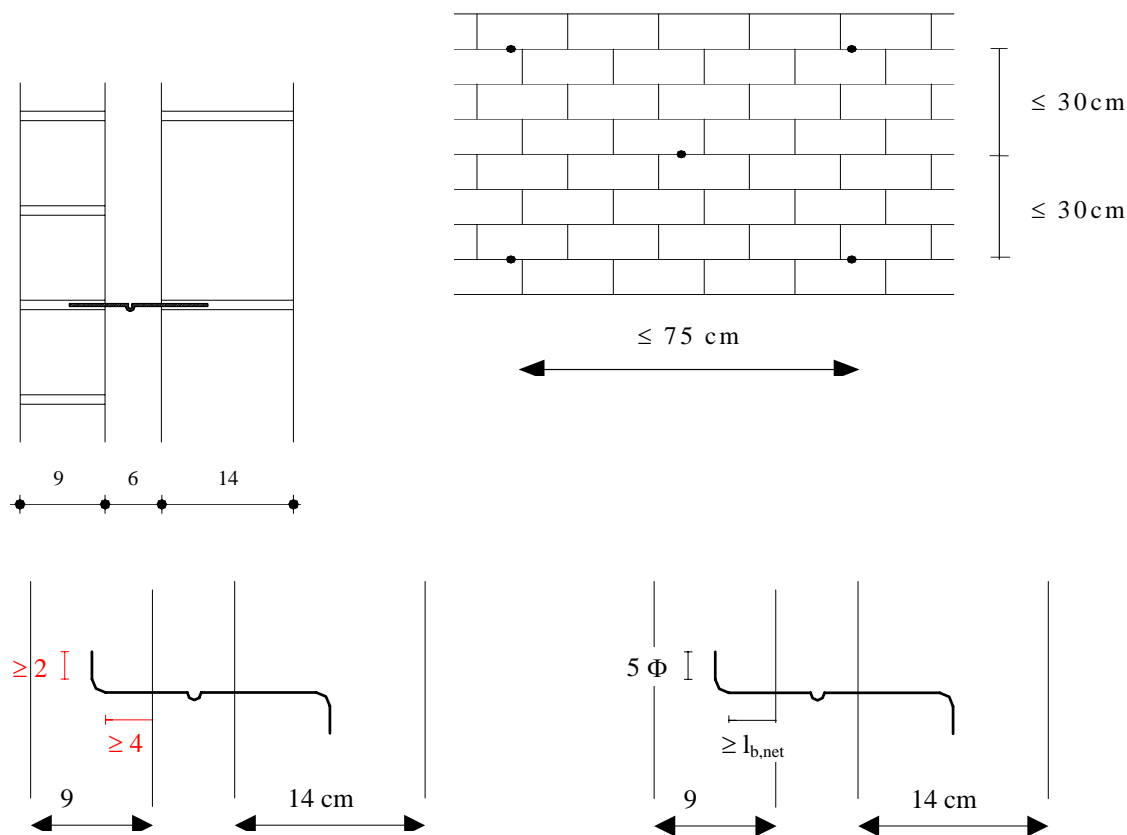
Liaisonnement du parement en briques au mur porteur
